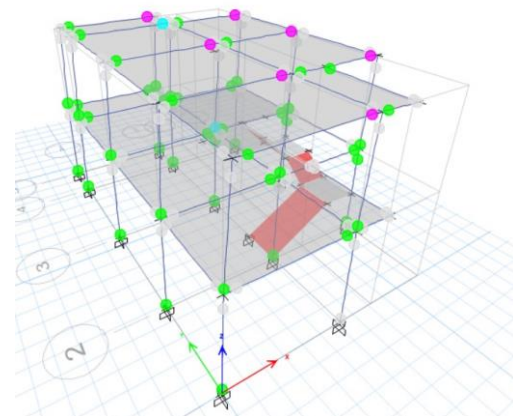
Formación de rotulas plásticas en vigas y columnas.
